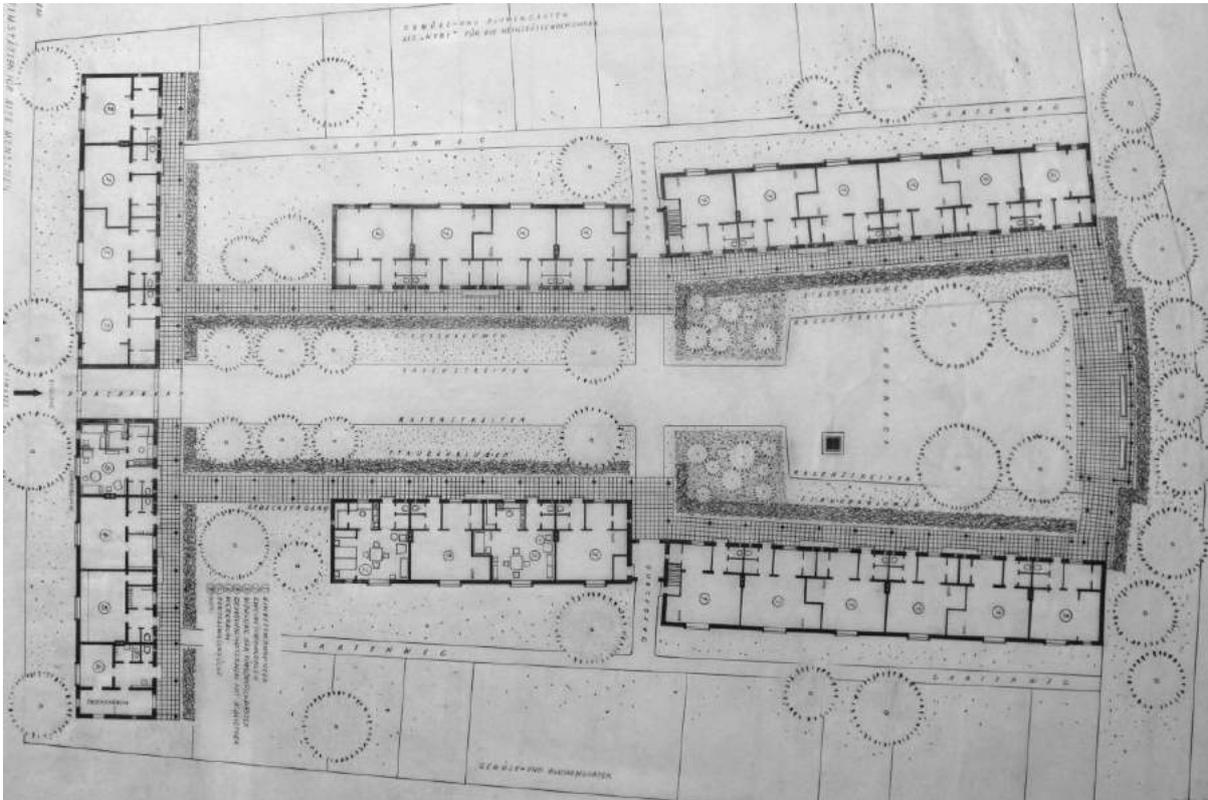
Grundriss Heimstätte für alte Menschen
